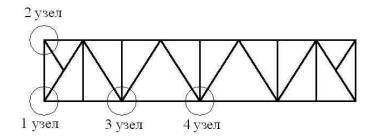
Схема к расчету и конструированию узлов фермы
